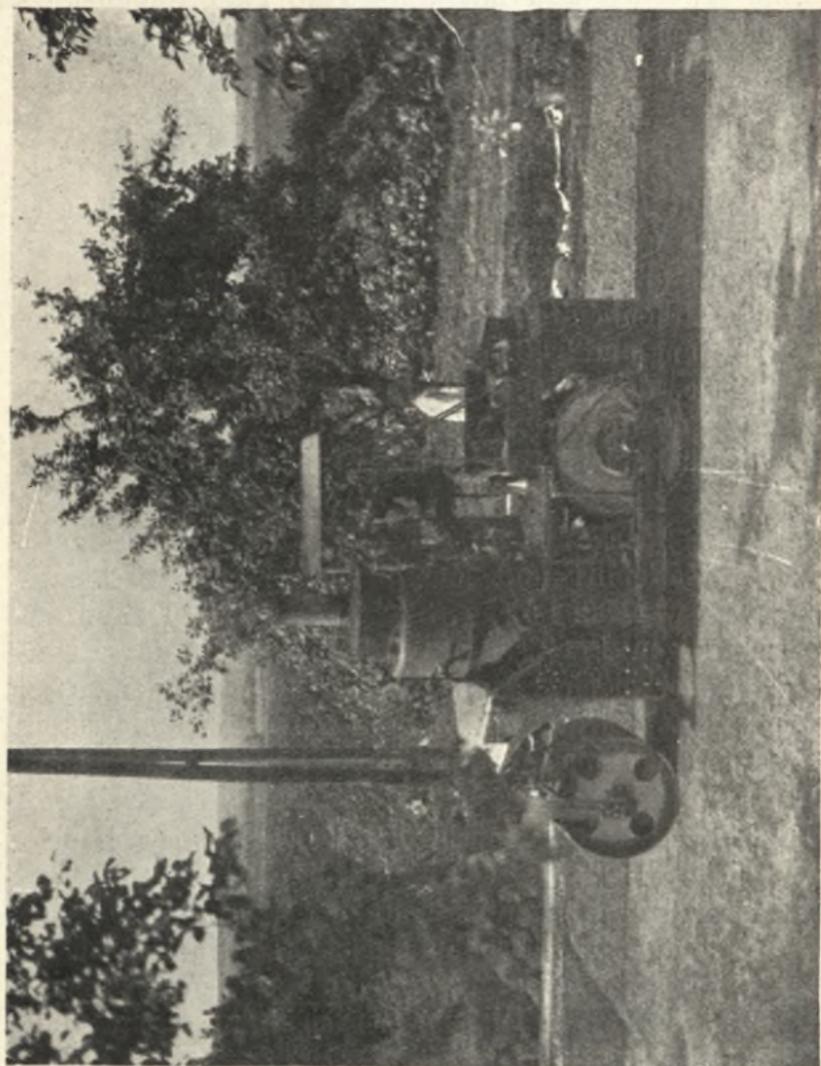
Rhoubénite-Betonstraße in Erfurt. Abwalzen der Oberfläche.
